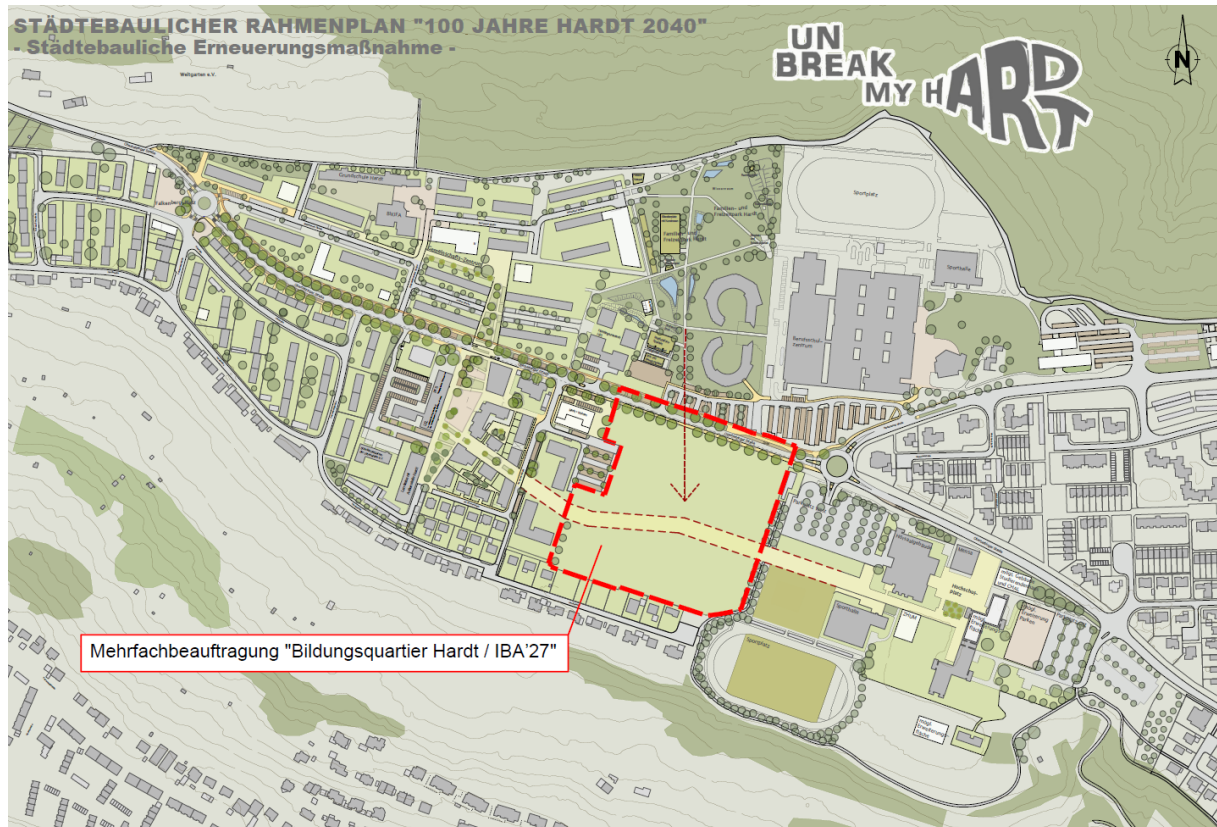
Vorgaben aus dem Rahmenplan © Stadt Schwäbisch Gmünd
